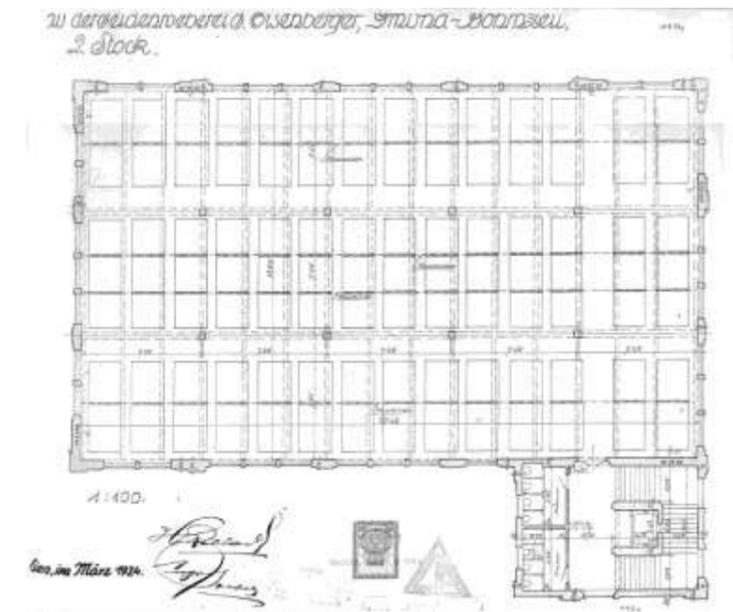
Grundriss Webereigebäude – Einreichplan 1924
